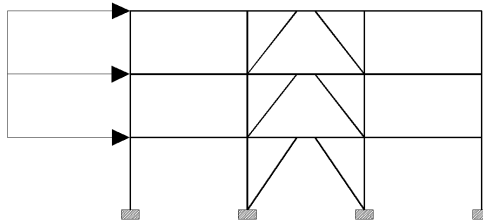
Distribución constante de fuerzas laterales.
